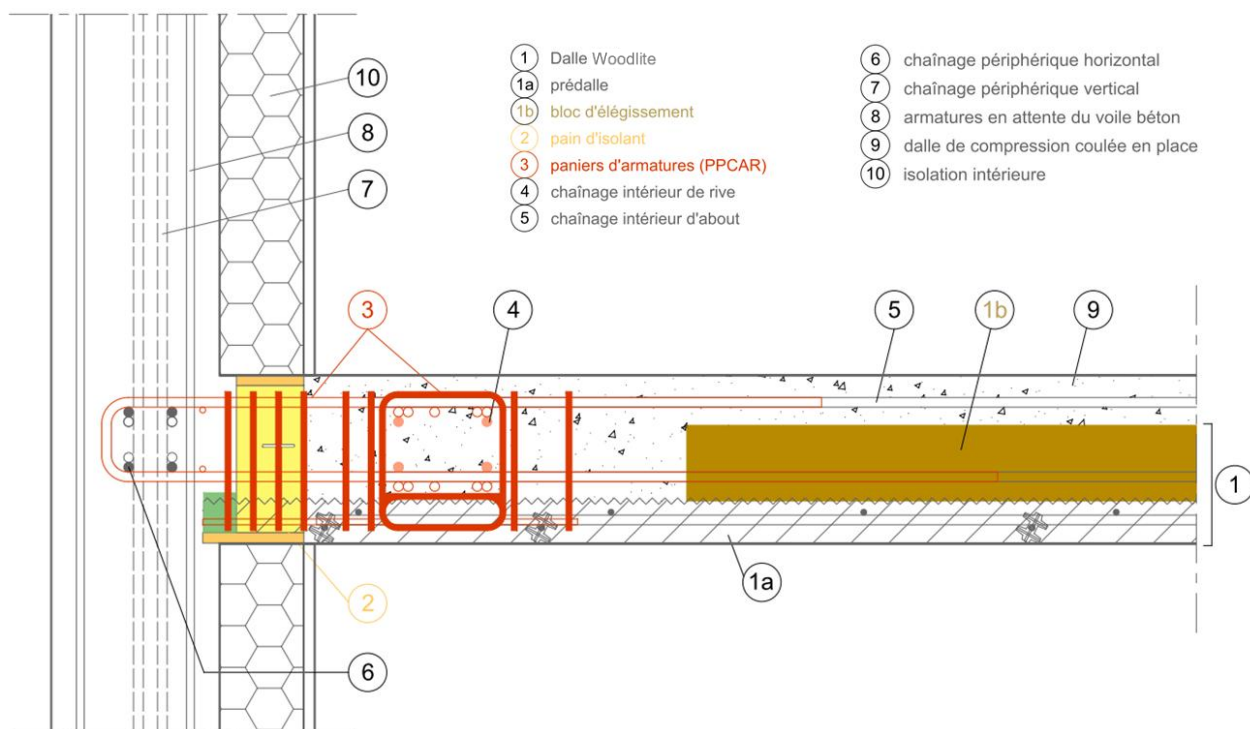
liaison voile-plancher – cas d'une Dalle WOODlite associée à la ThermoPrédalle® BA 0,45 RECTOR
